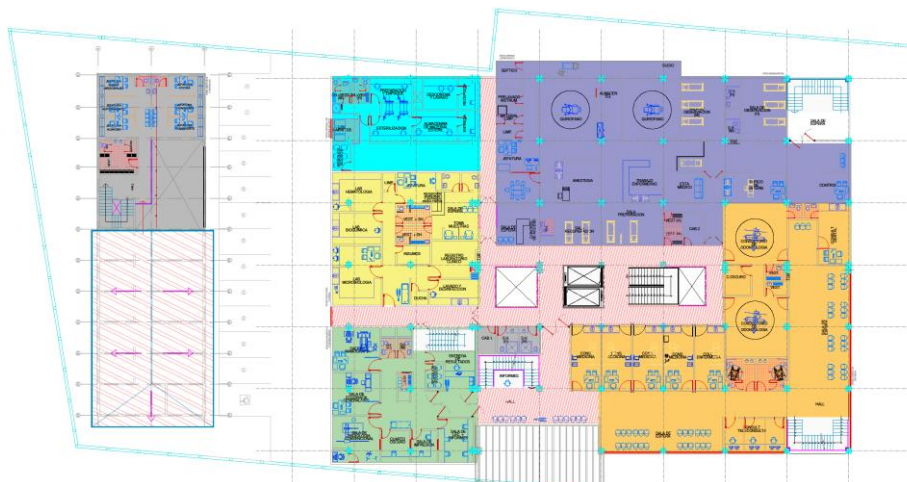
Planta arquitectónica de la edificación, nivel 02.
